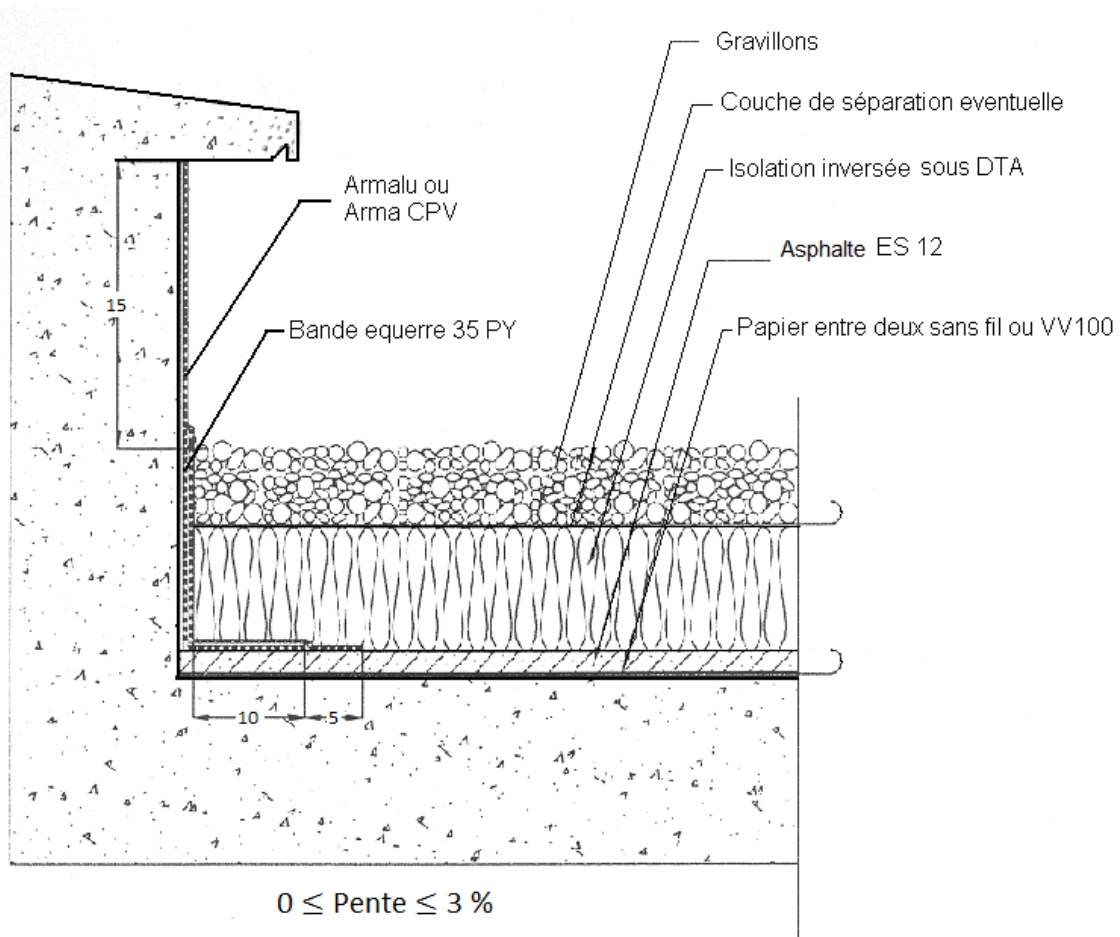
Relevés / Coupe type, avec équerre de renfort sur l'asphalte – Terrasse inaccessible, protection par gravillons
